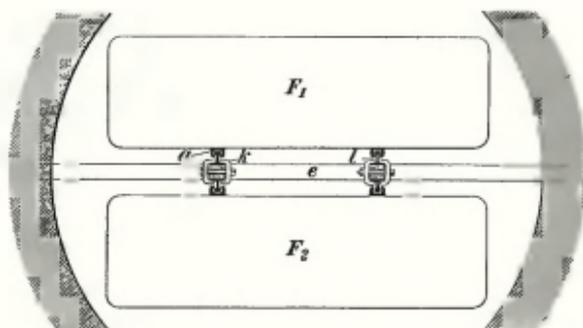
Briartsche Führung mit einem Mitteleinstrich.
